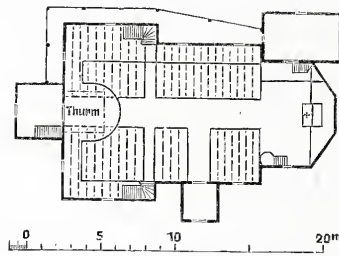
Grundriß, Evang. Kirche in Bürgsdorf.
